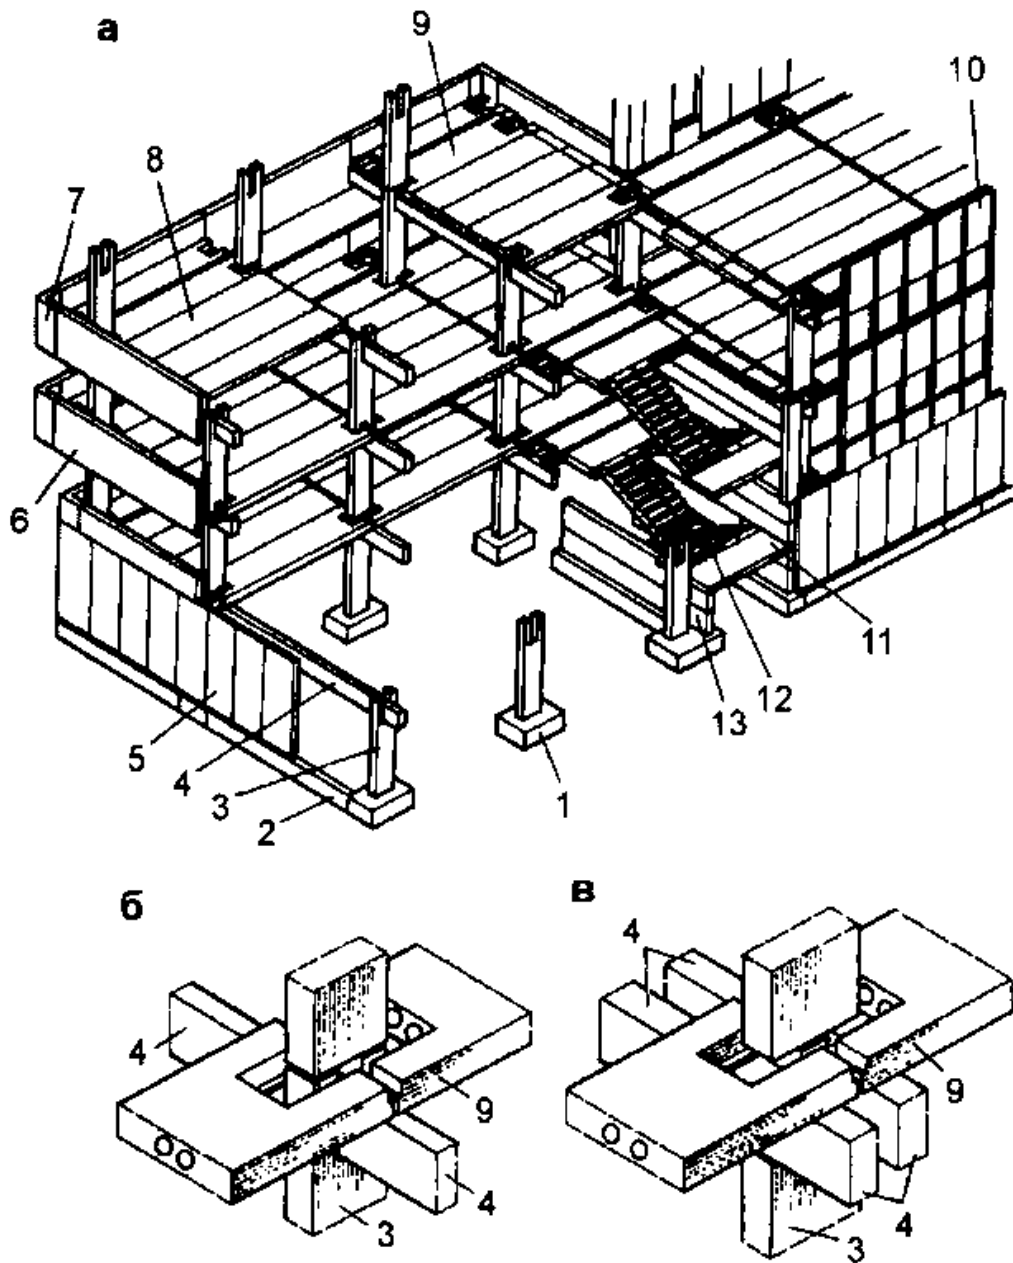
Каркасна будівля системи: а – основні елементи будівлі; б – одноригельне рішення вузла каркаса; в – дворигельний; 1 – фундамент склянкового типу під колону; 2 – стрічковий монолітний фундамент під стіну підвалу; 3 – колона; 4 – ригель; 5 – панель стіни підвалу; 6 – рядова горизонтальна панель зовнішньої стіни; 7 – кутовий елемент стіни; 8 – рядова плита перекриття; 9 – плита-розпірка; 10 – панель стіни вертикальної розрізки; 11 – сходовий майданчик; 12 – сходовий марш; 13 – панель стіни сходової клітки
